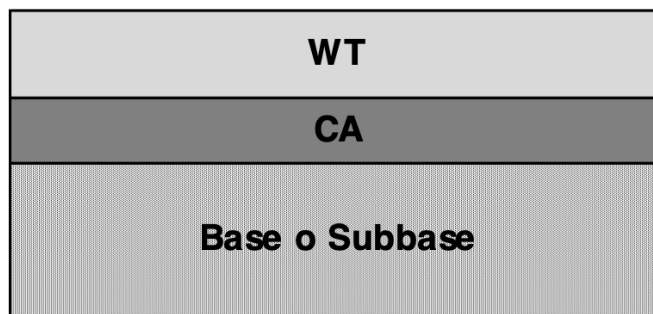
Sección transversal típica #2 de un pavimento compuesto. Fuente: Andrade Triviño y Franco Puga (2019).
